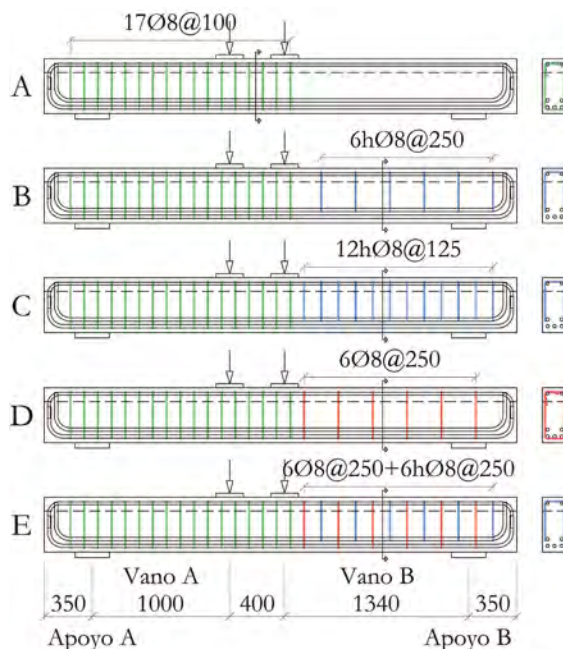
Disposición de armado de las vigas. Unidades: mm.
